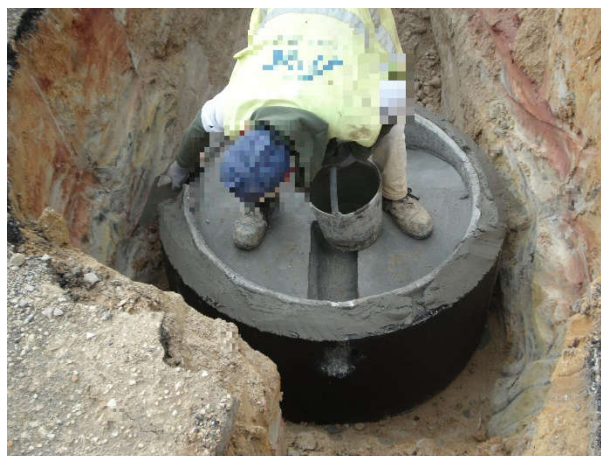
Colocação de argamassa entre elementos pré-fabricados da câmara de visita
